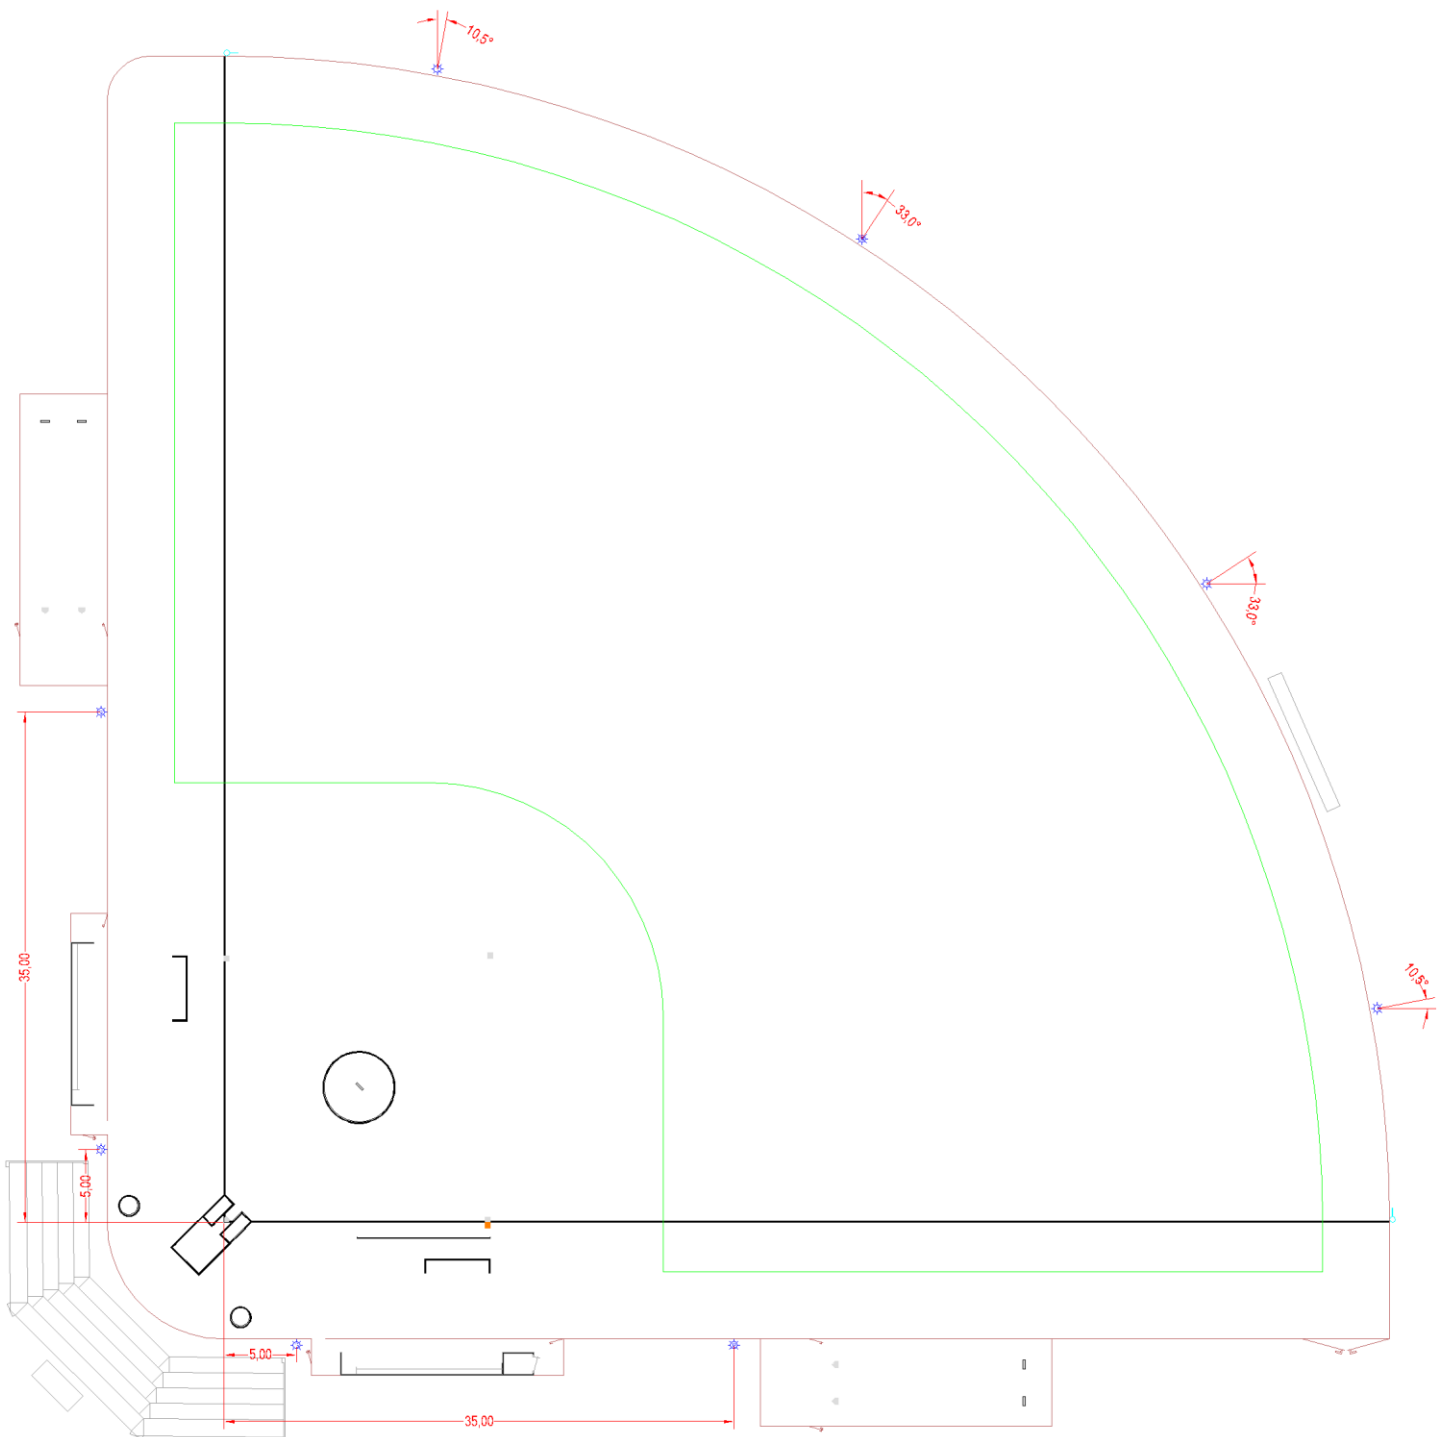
Plaatsingsschema lichtmasten honkbalveld
